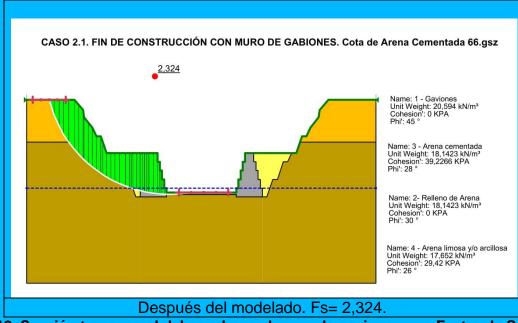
Sección transversal del canal con el muro de gaviones con Factor de Seguridad de Falla Global.
